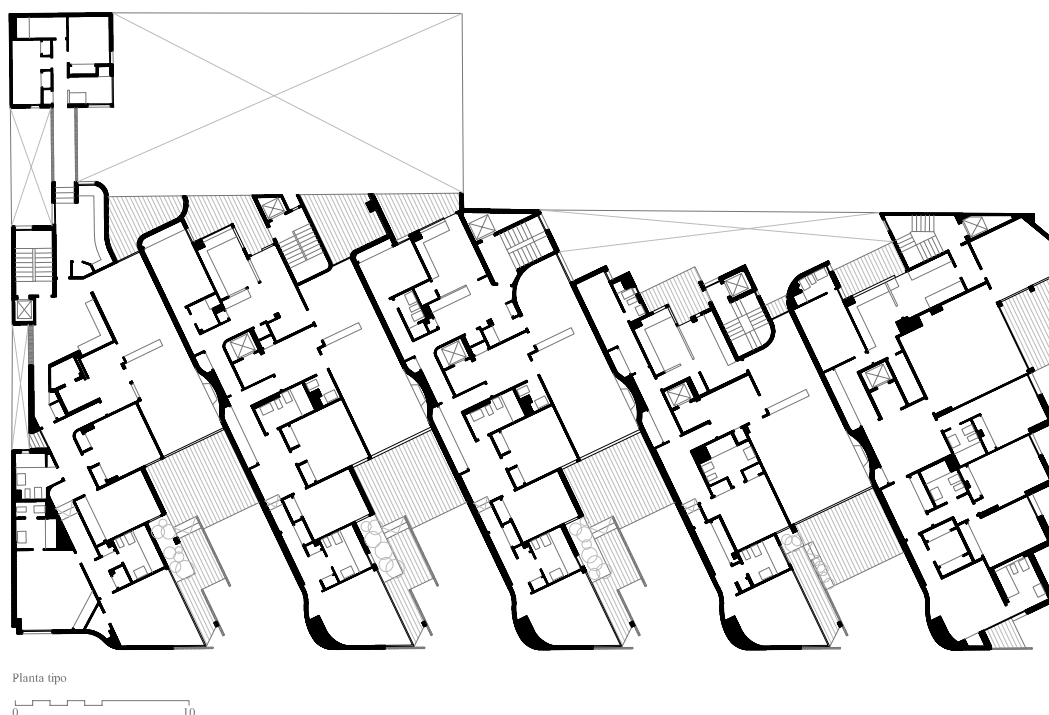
Edificio Girasol. Planta tipo. Dibujo de los autores.
